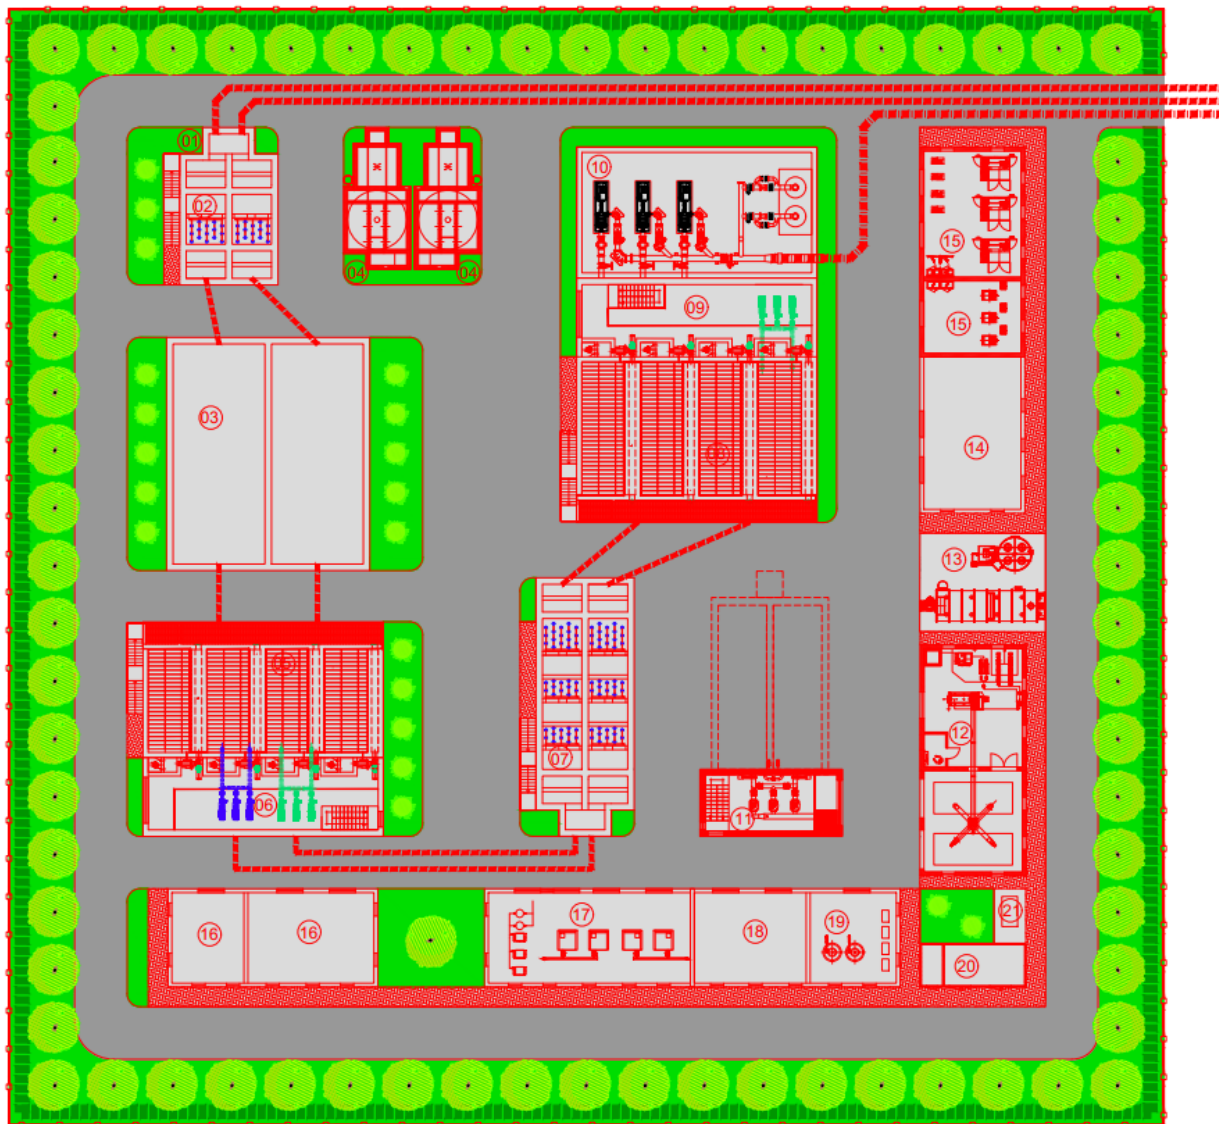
Impianto di potabilizzazione – piantumazioni in progetto
